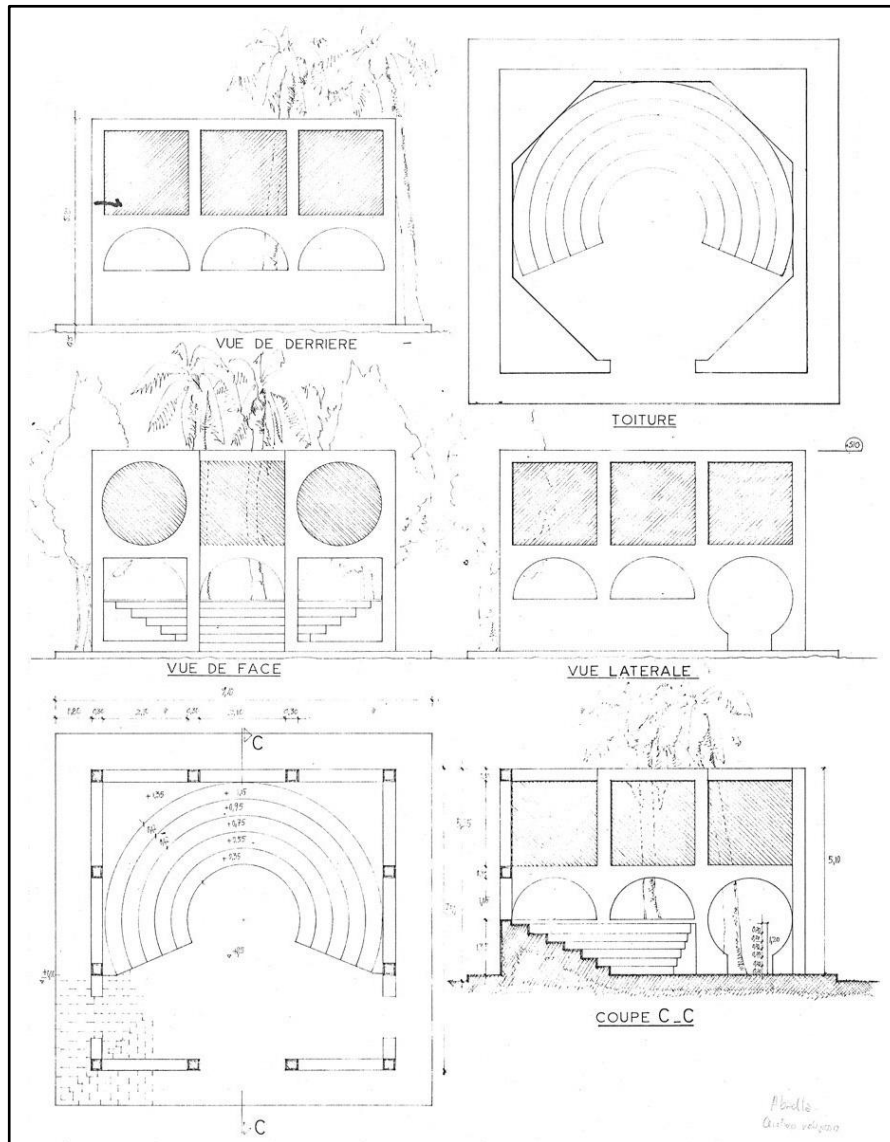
plans coupes façades de l'espace de rencontre et de spectacle, Machrâa houari Boumediene
